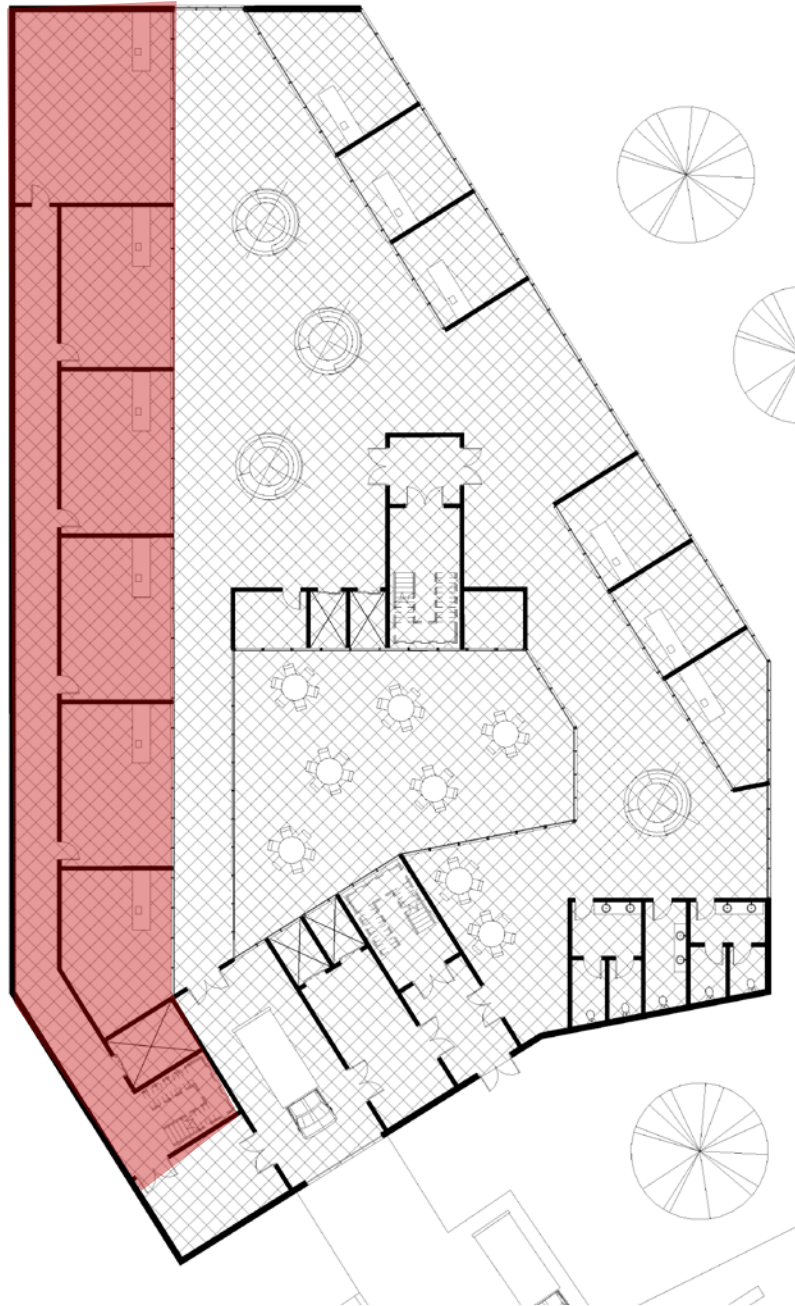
Representação em planta dos armazéns, bem como o seu acesso e elevador monta cargas, por meio de planta
